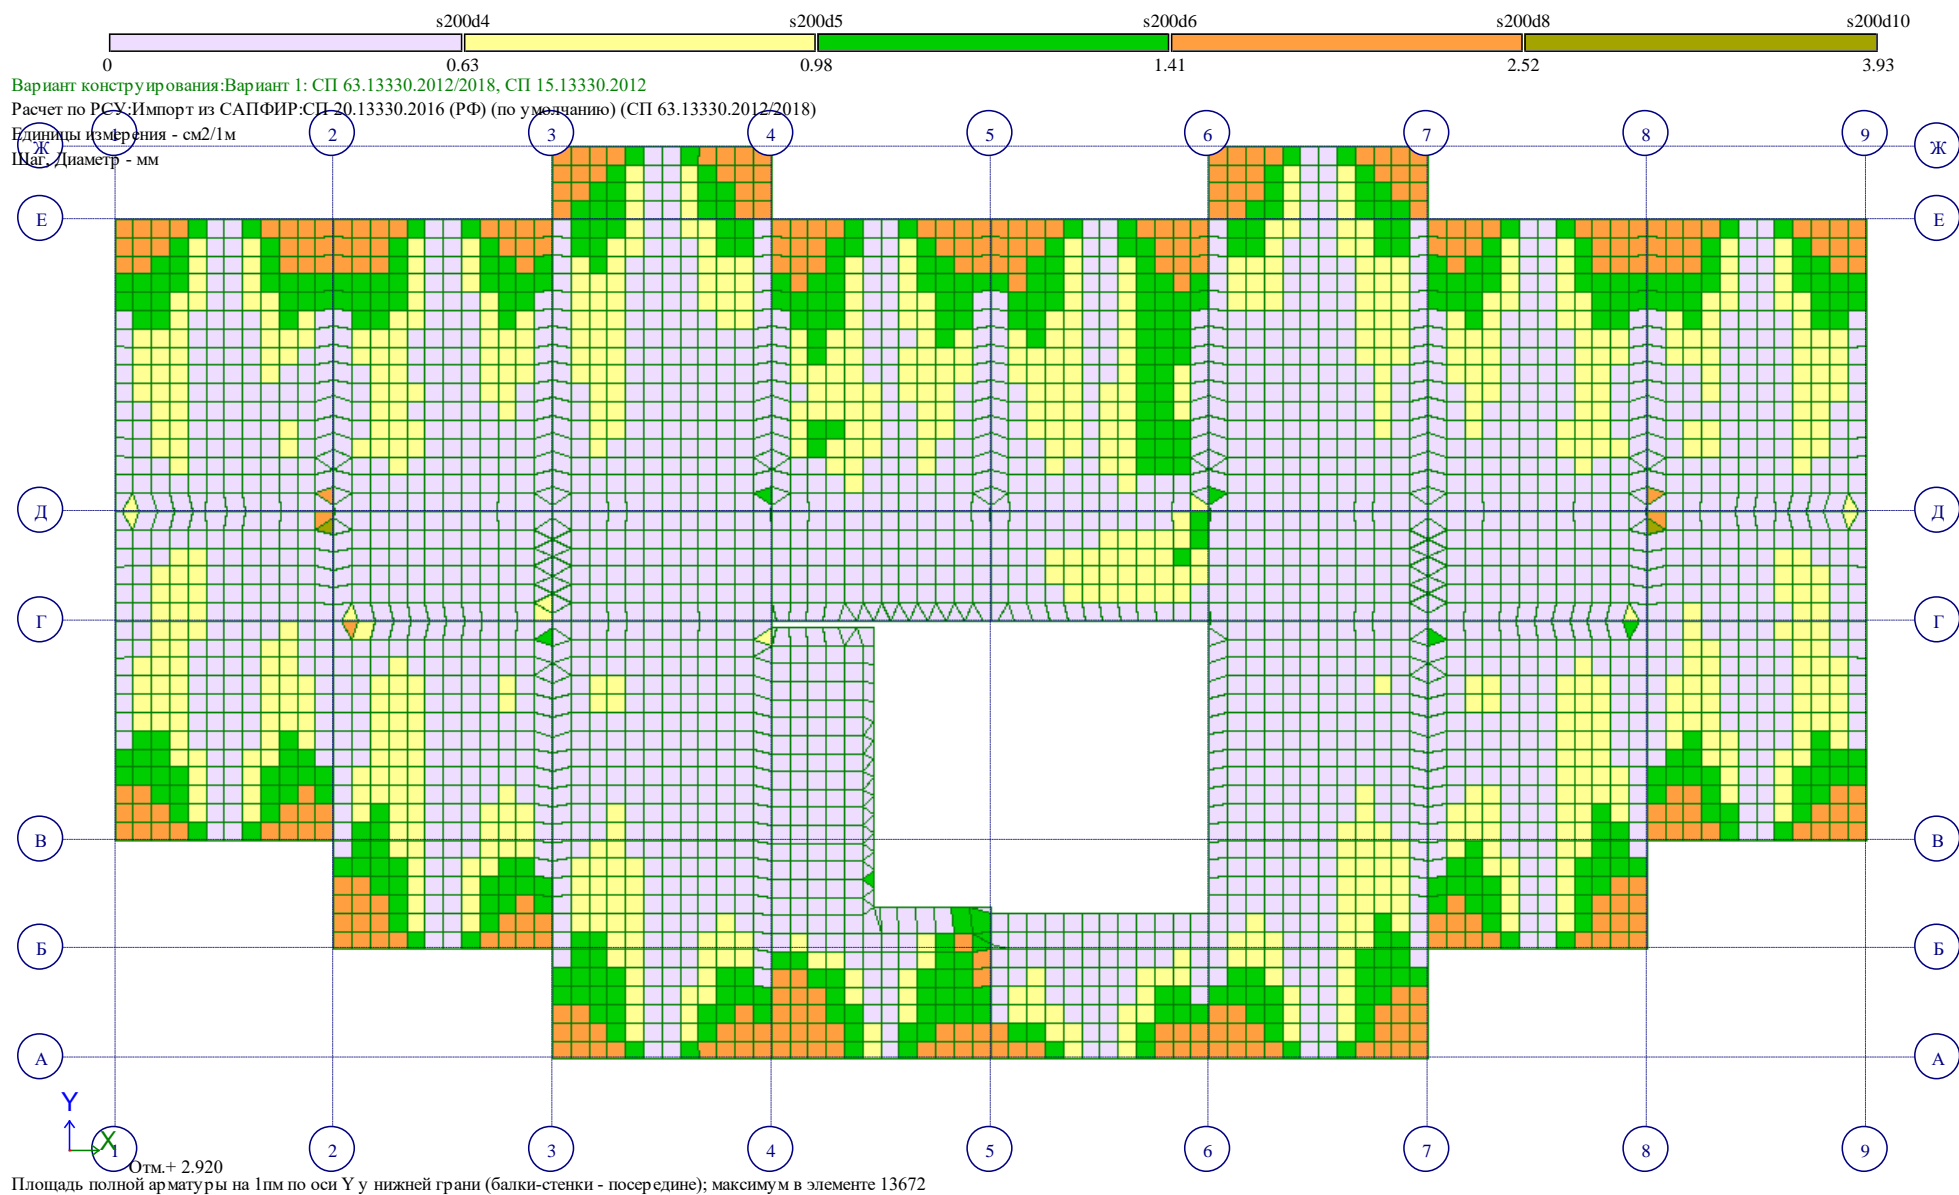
Площадь полной арматуры на 1м по оси Y у нижней грани
